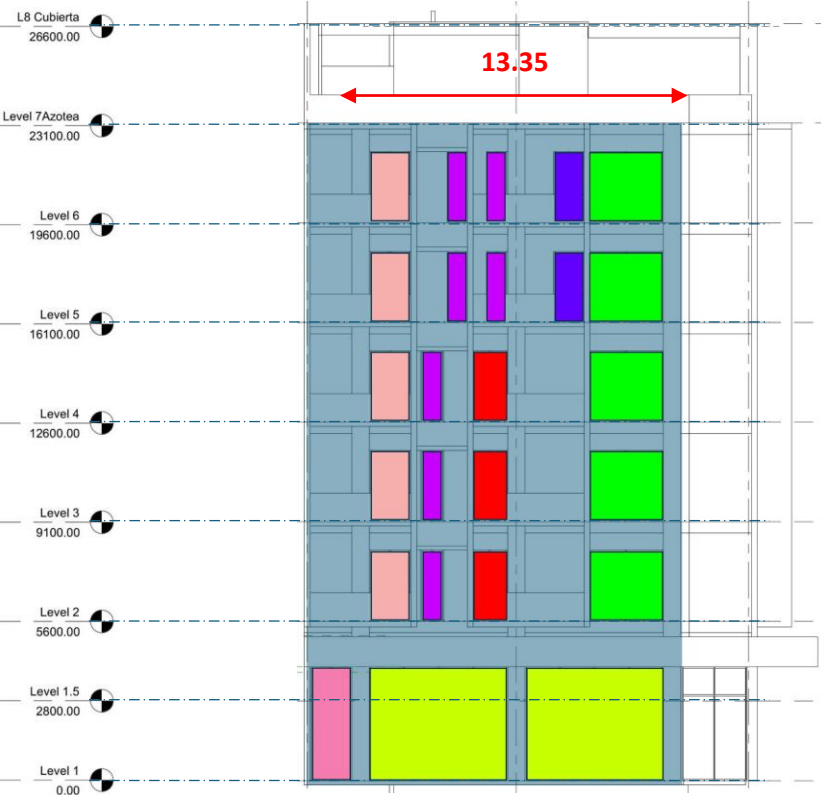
Aberturas para iluminación en la fachada sur, según propuesta de anteproyecto
